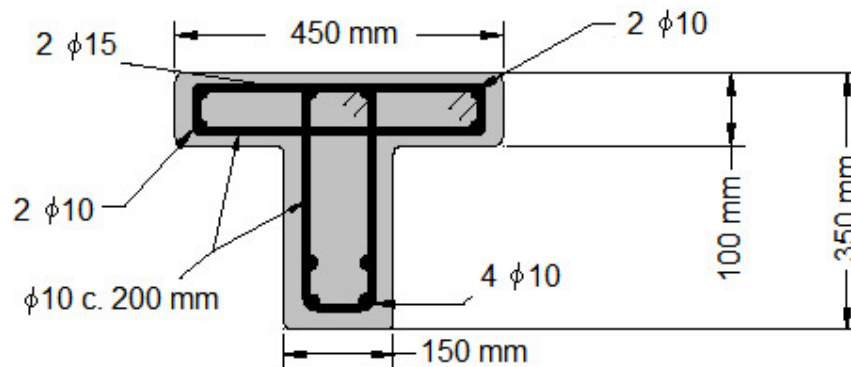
Seção transversal das vigas T (Deifalla e Ghobarah, 2006).
